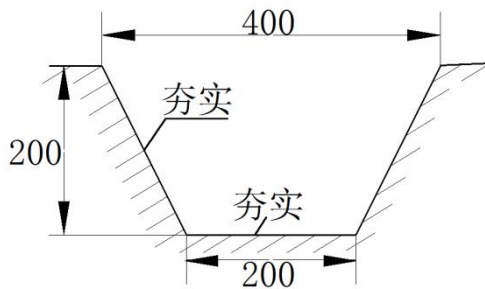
开采平台截（排）水沟大样图（单位：mm）
